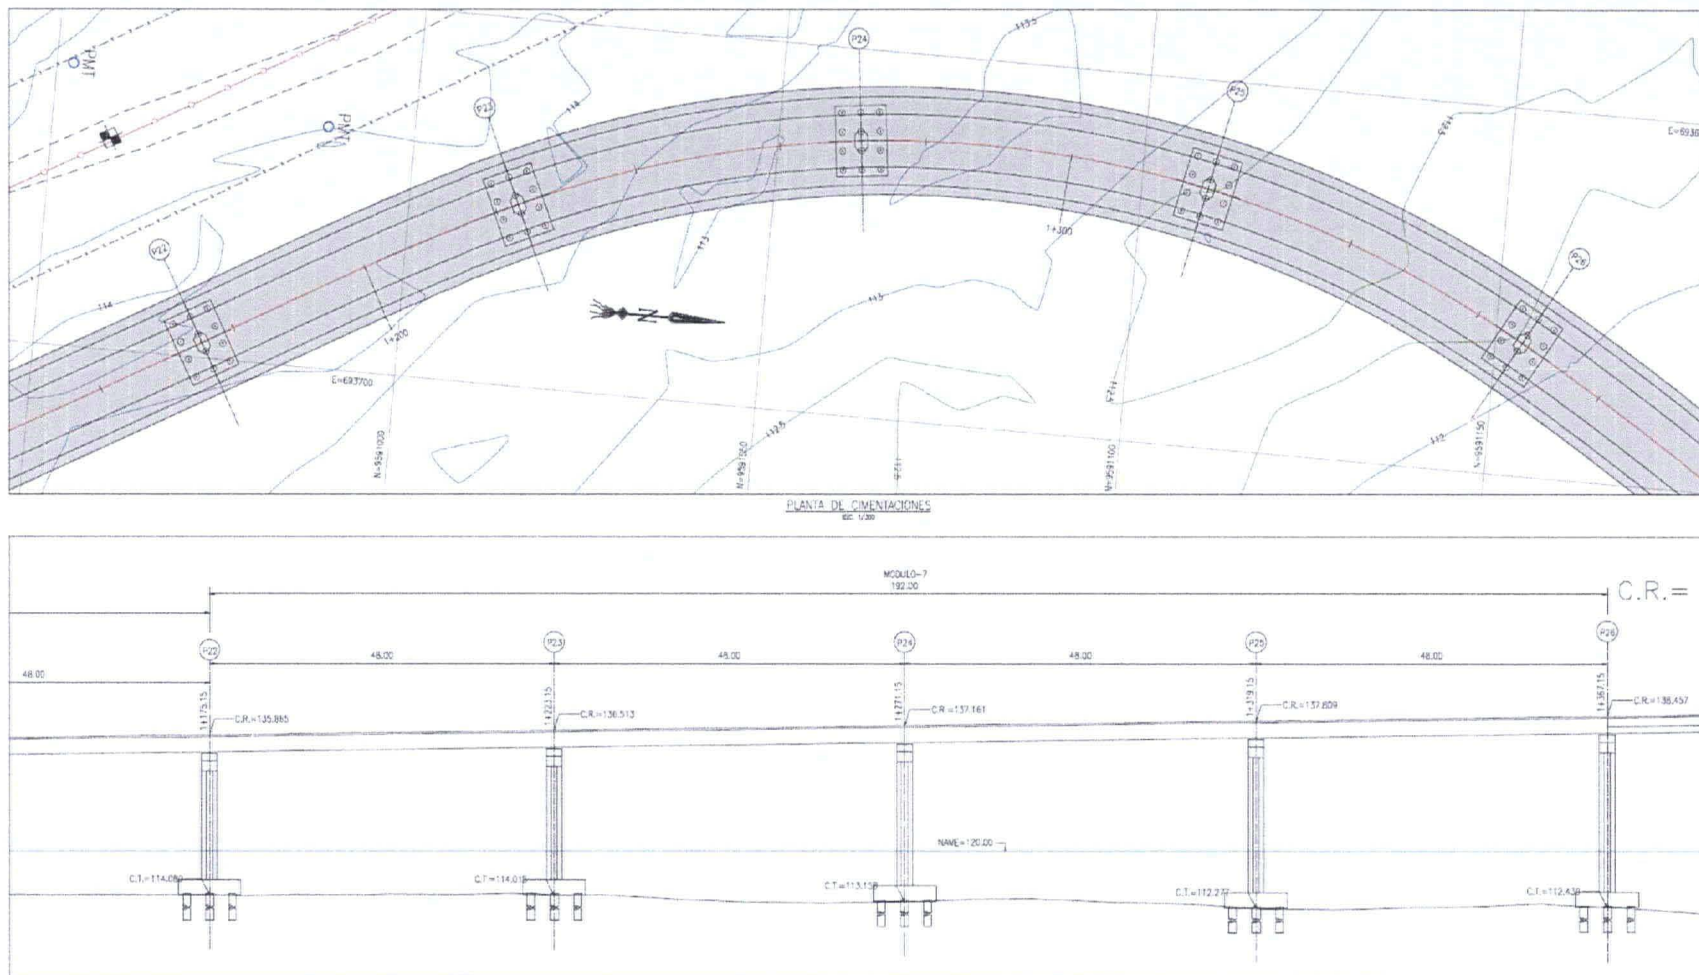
Viaducto: Módulo Típico Curvo, Planta y Elevación
